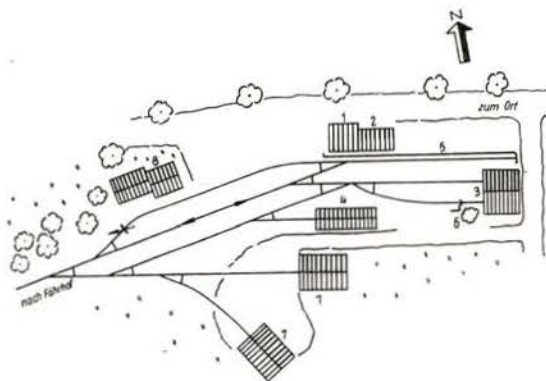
Lageplan des Bahnhofs Altenkirchen:
